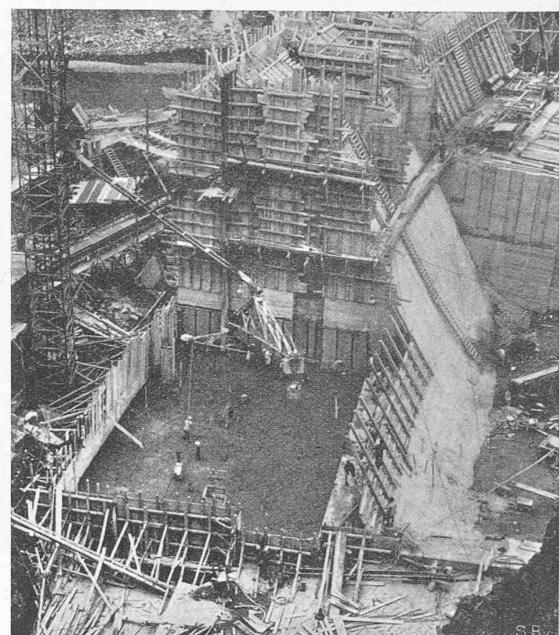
Betonieren des Ueberfalles der rechten Mauerhälfte,
